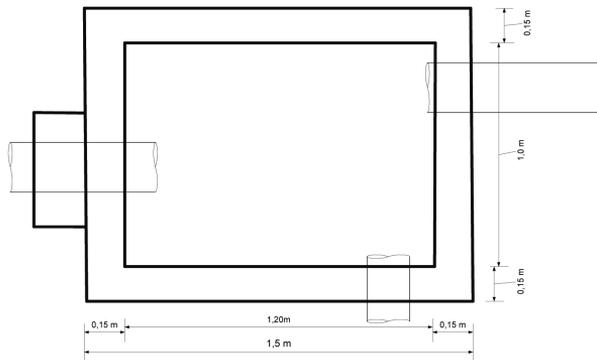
Diseño de planta de la cámara intermedia en el canal 1 de Cebollullo
